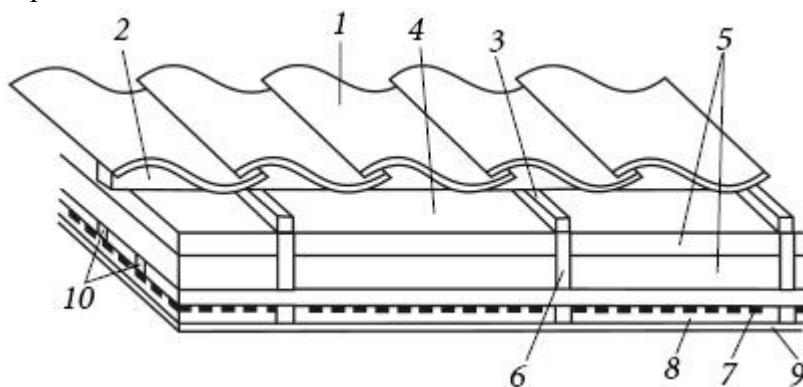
Теплоизоляция скатов кровли со стропилами в «холодной зоне»: 1) покрытие кровли; 2) обрешетка; 3) контробрешетка; 4) гидроизоляция; 5) теплоизоляция; 6) стропила; 7) пароизоляция; 8) вентиляционный зазор; 9) декоративные плиты потолка; 10) нижняя обрешетка
